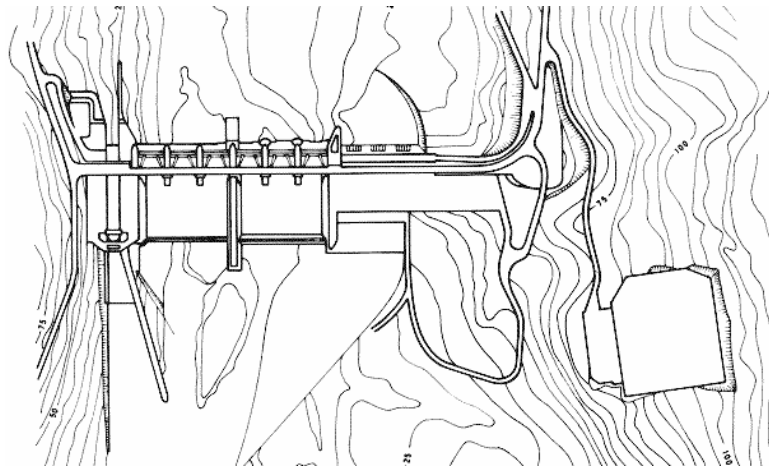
Planta da Barragem de gravidade do Carrapateiro (CNPGB).
